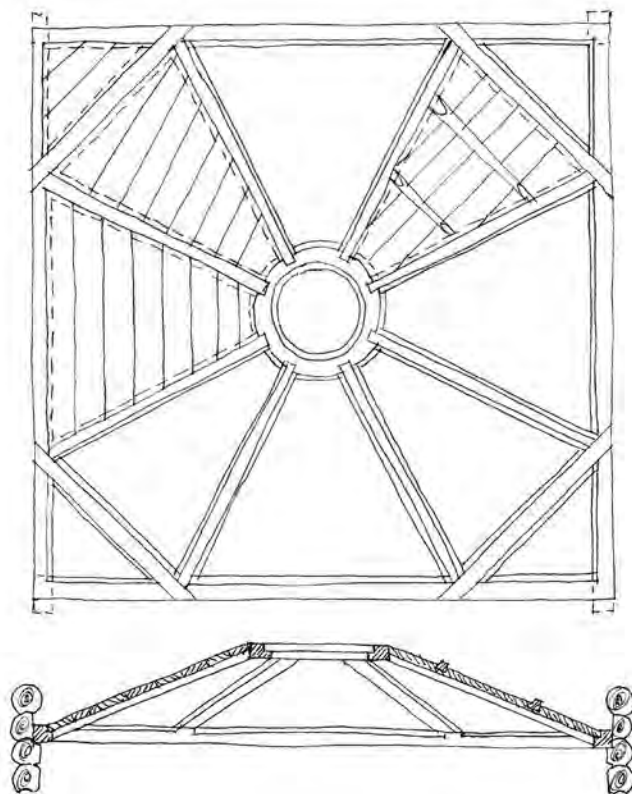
Схема каркасных «небес» на 8 граней с примерами различных заполнений граней. План, разрез
